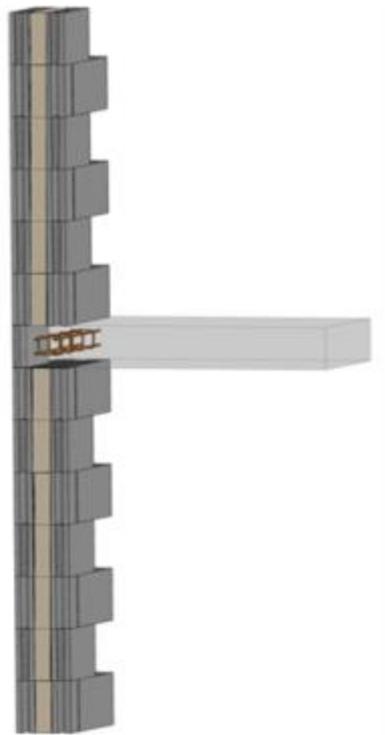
Chaînage horizontal (appui de plancher) – Mur « R1 N »
